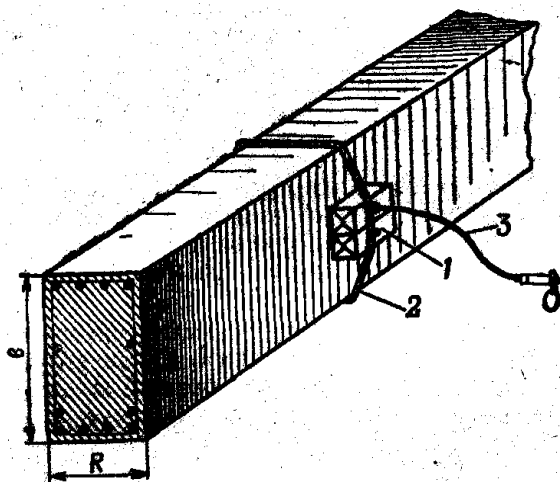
Взрывание железобетонной балки наружным сосредоточенным зарядом:
